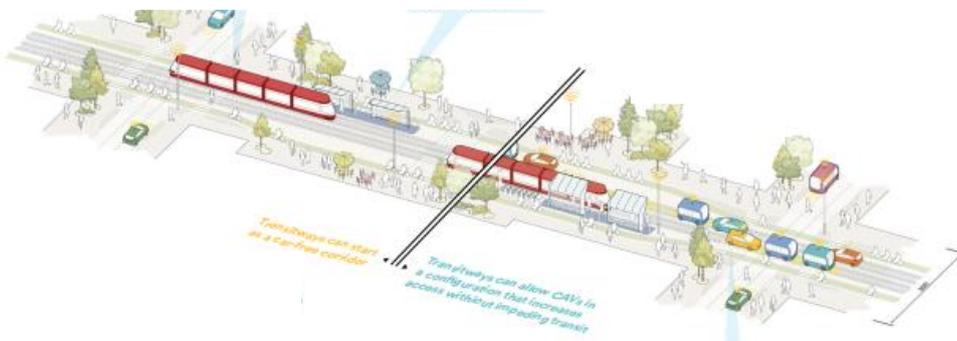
Ilustrasi penerapan *complete street* pada jalan *laneway
